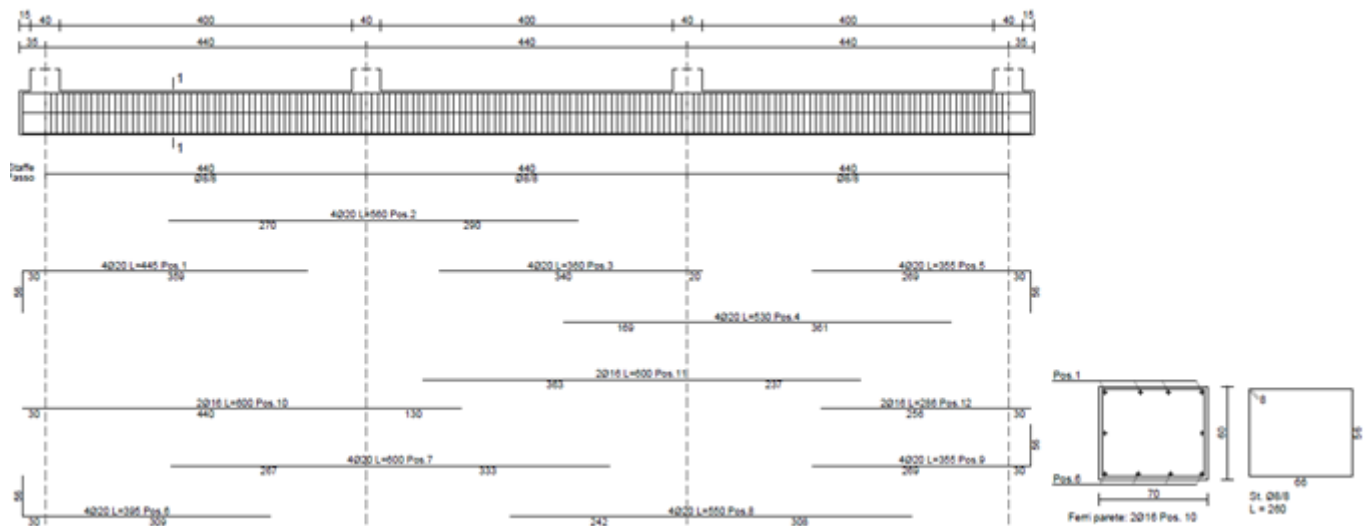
Tipologico ferri di armatura travi principali di fondazione
